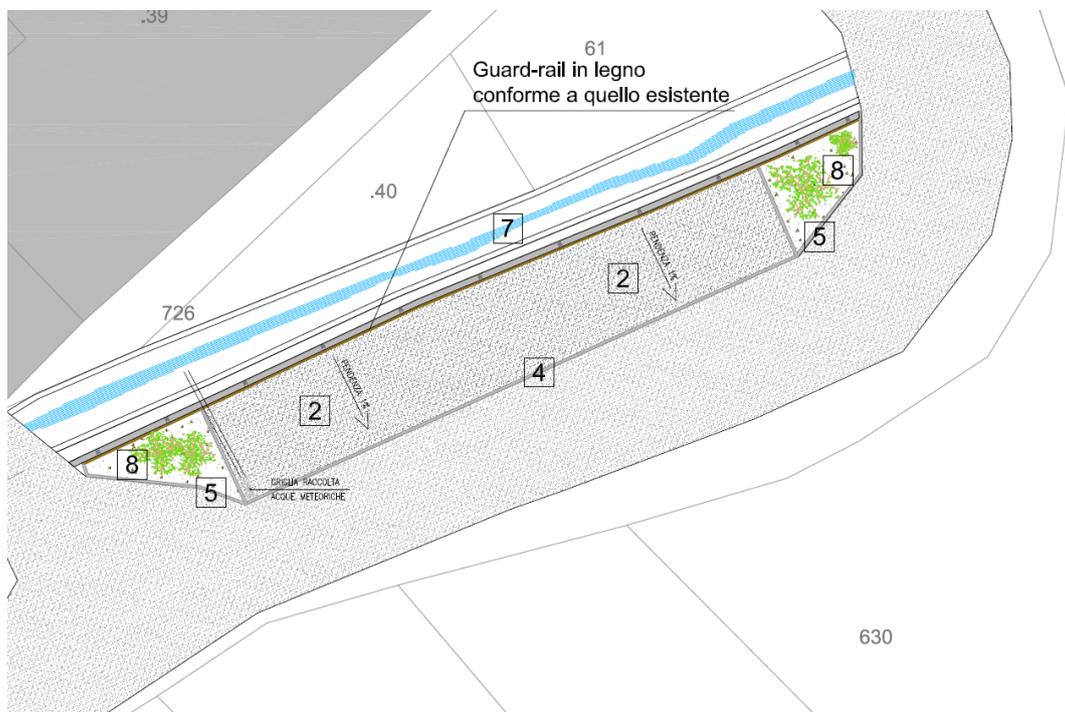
Estratto "Planimetria generale di progetto - *intervento 1*" scala a vista.
